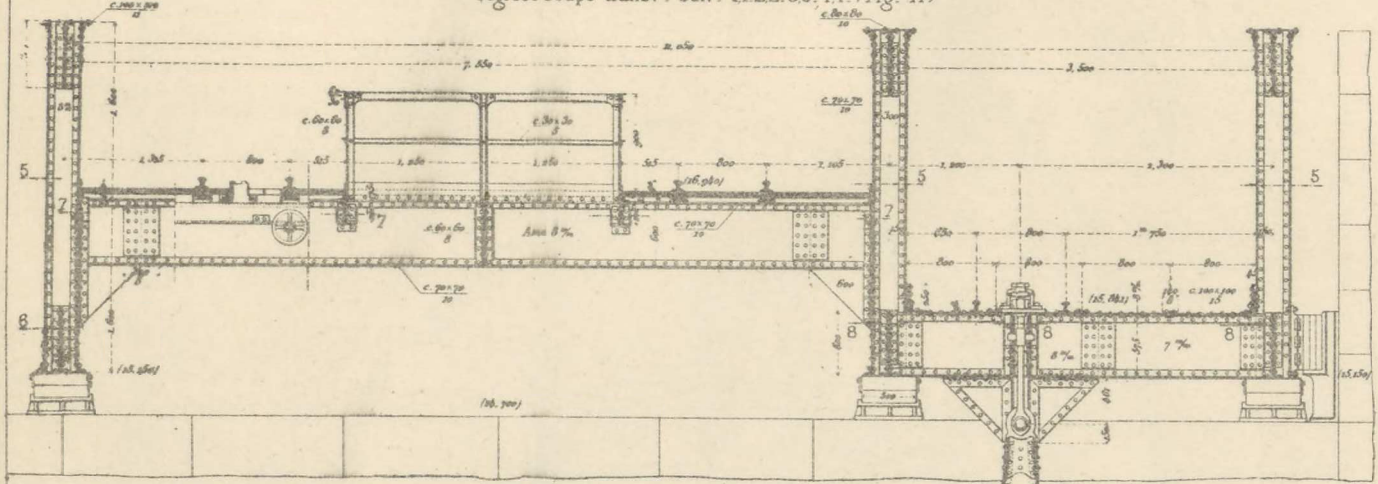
Plan et coupes horiz. suiv. 555 et 6.777.888. (Fig. 10)
